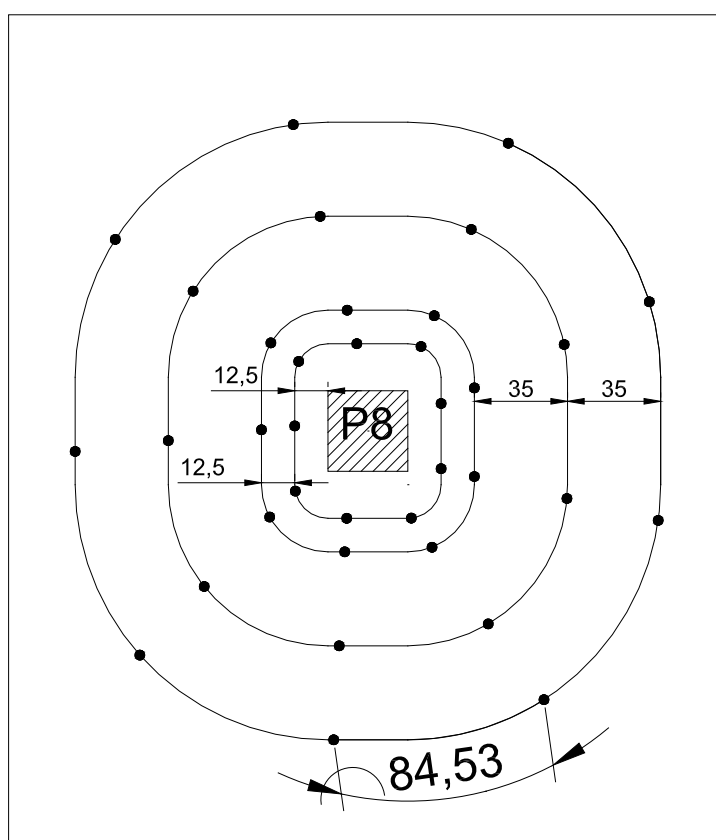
DISPOSIÇÃO DA ARMADURA DE PUNÇÃO PARA O PILAR P8 SEGUNDO A NBR 6.118:2003
